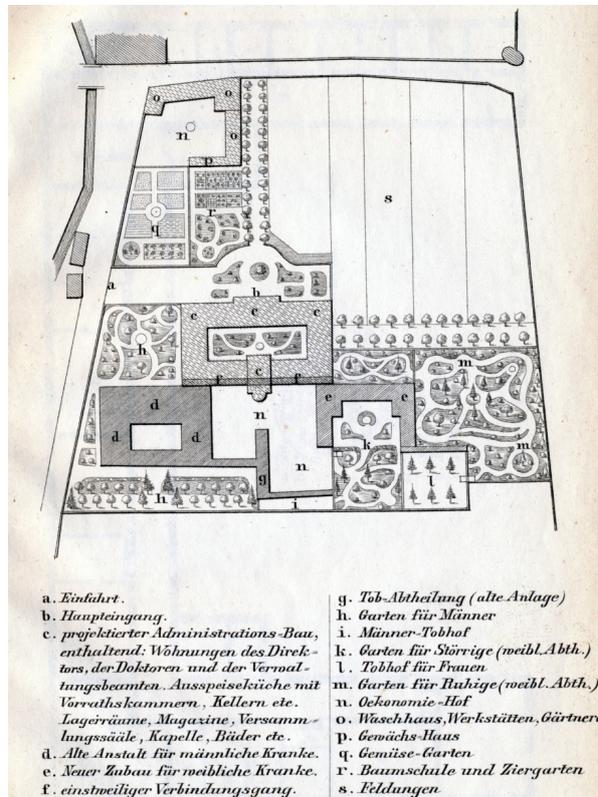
Lageplan Landes-Irrenanstalt Hall, 1869
